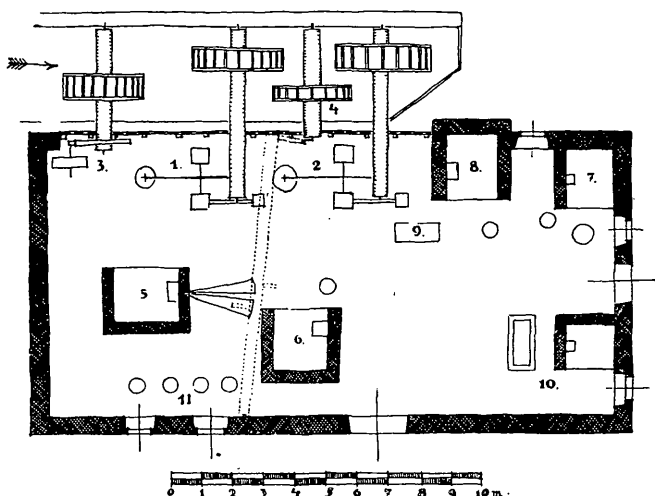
Plan des Sensenhammers in Schmiedleiten, Leonstein. Umgebaut 1870.
